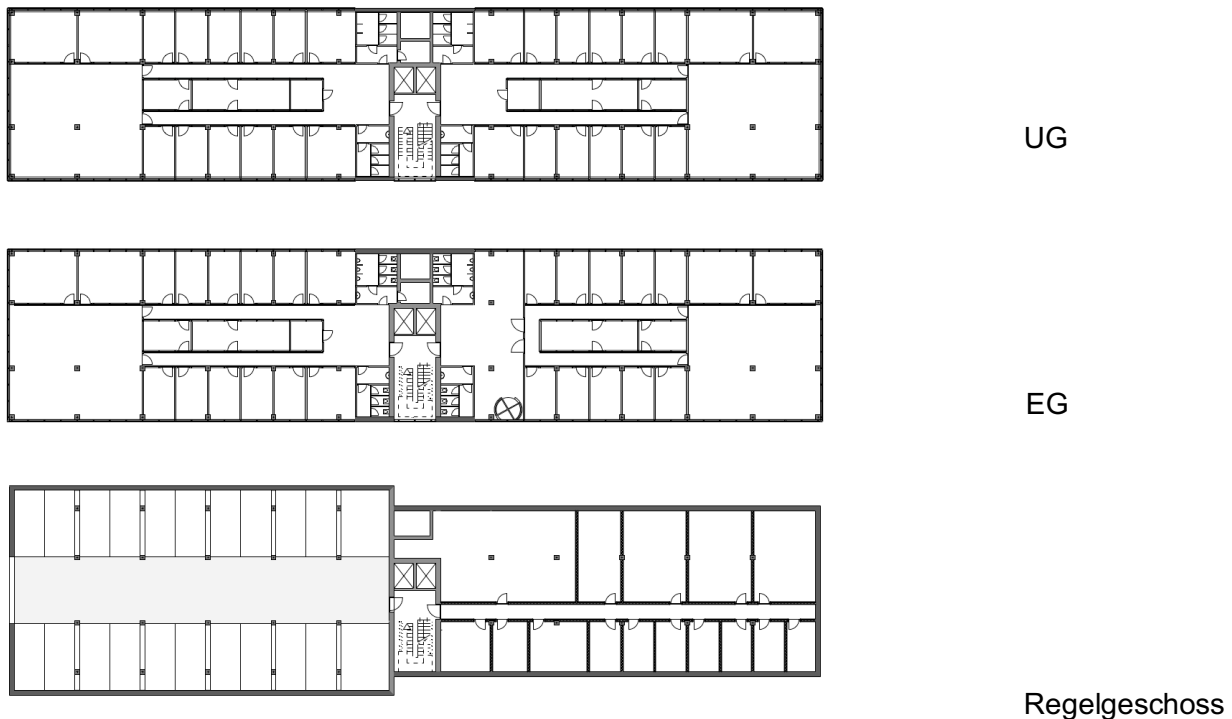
Grundrisse Untergeschoss, Erdgeschoss und Obergeschoss⁴⁶⁴
